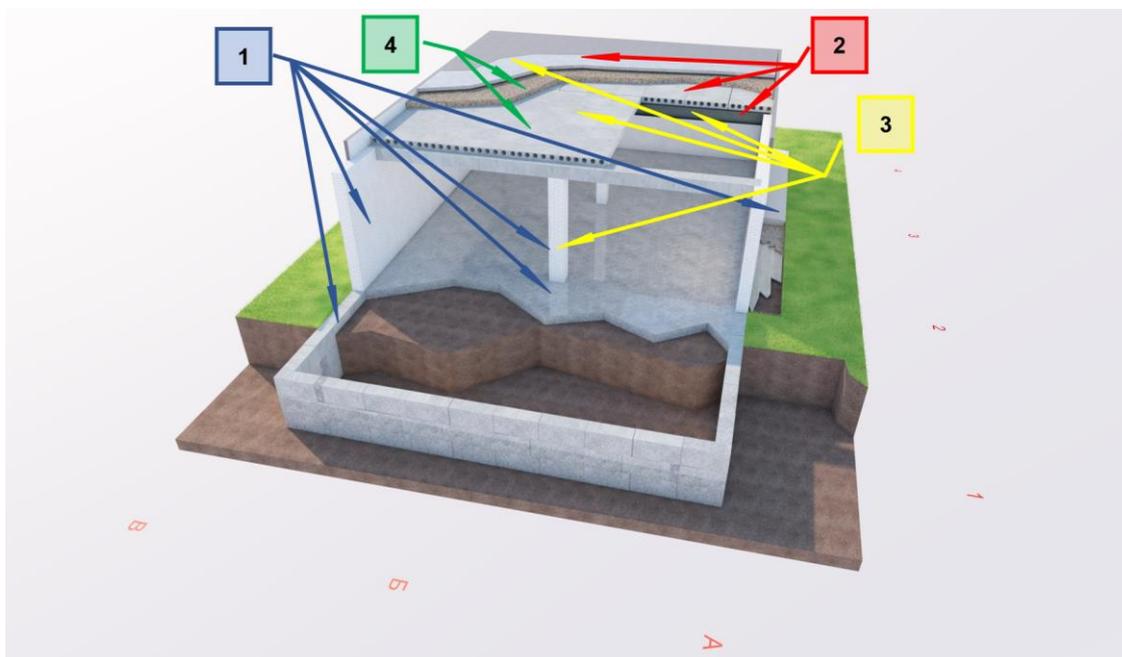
условная схема определения областей отказа в строительных конструкциях выбранного здания: 1 – ОО стен и фундаментов; 2 – ОО балок; 3 – ОО кирпичных колон; 4 – ОО плит покрытия;
